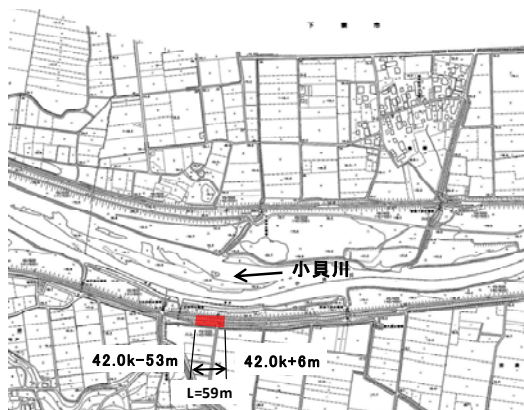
43 被災箇所の平面図(関東地方整備局提供)
